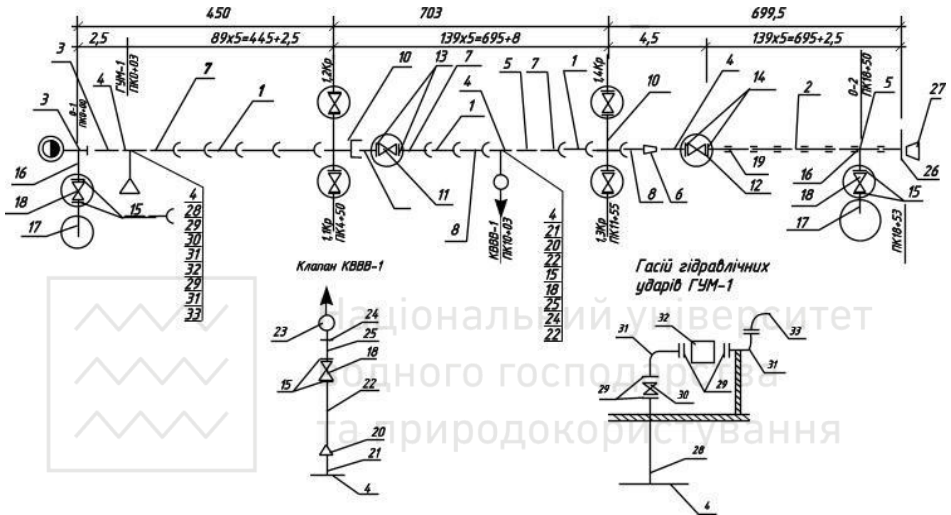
Деталювальна схема для трубопроводу 1 Кр під ДМ “Днепр”
